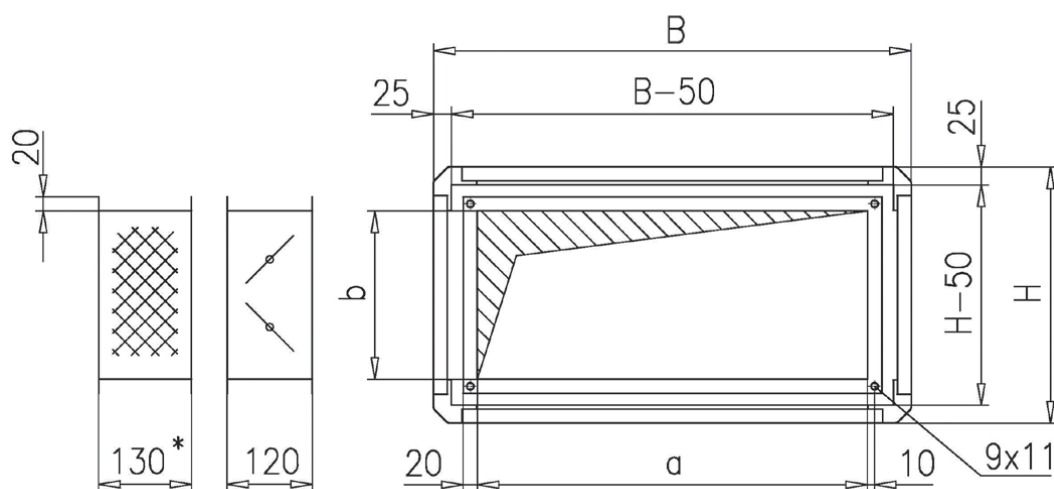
Габаритные и присоединительные размеры установок А20...F (плоских, с алюминиевым профилем каркаса и толщиной стенки 20 мм)
